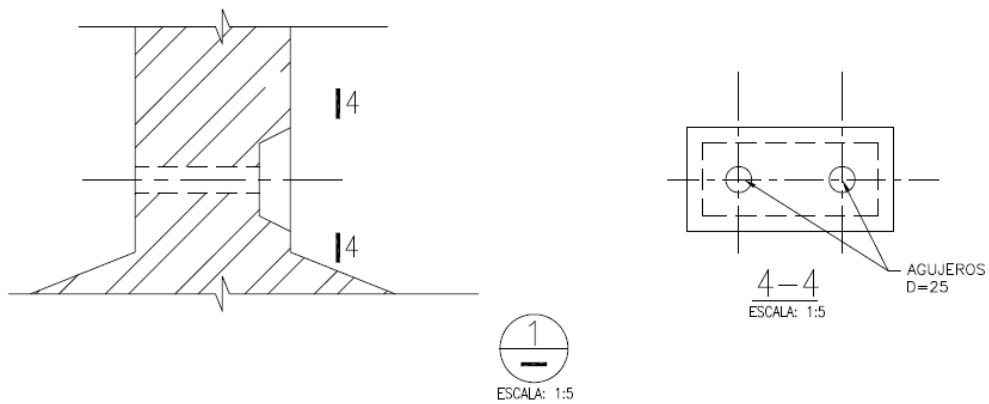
Detalles de agujeros de Vigas Puente WS-100 y WS-80.
